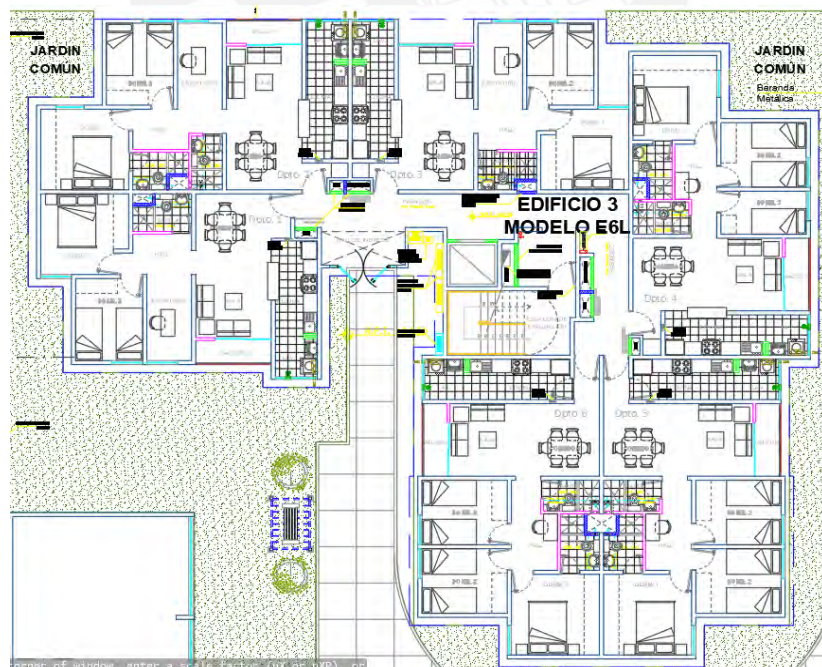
Planta de un edificio típico de 6 departamentos por piso.
